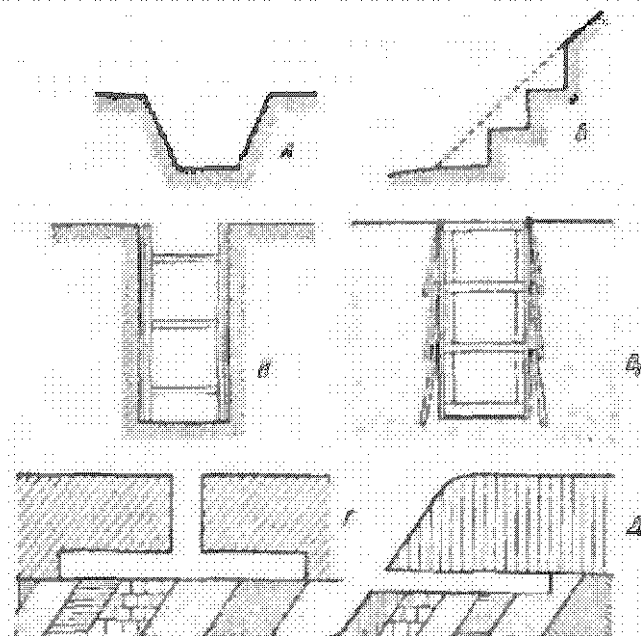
Горные выработки: А — канавы; Б — расчистка; В — с распорками крепления; В<sub>1</sub> — забойное крепление; Г — шурф с креплением; Д — шторм
